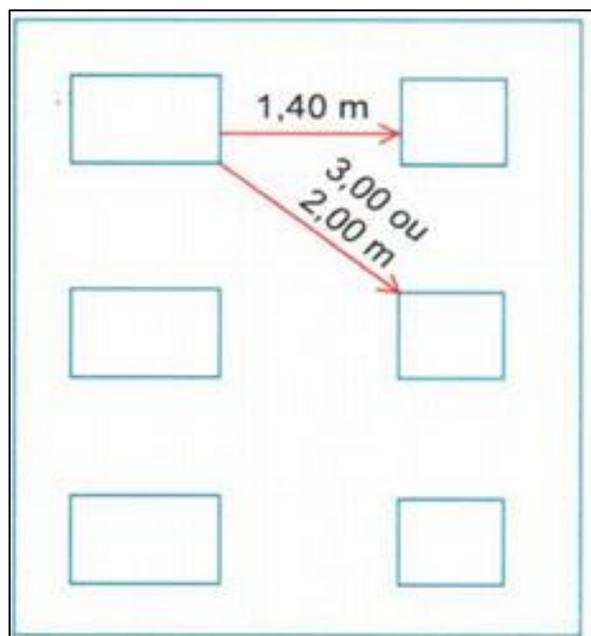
Elevação da distância de aberturas de escadas protegidas horizontalmente
